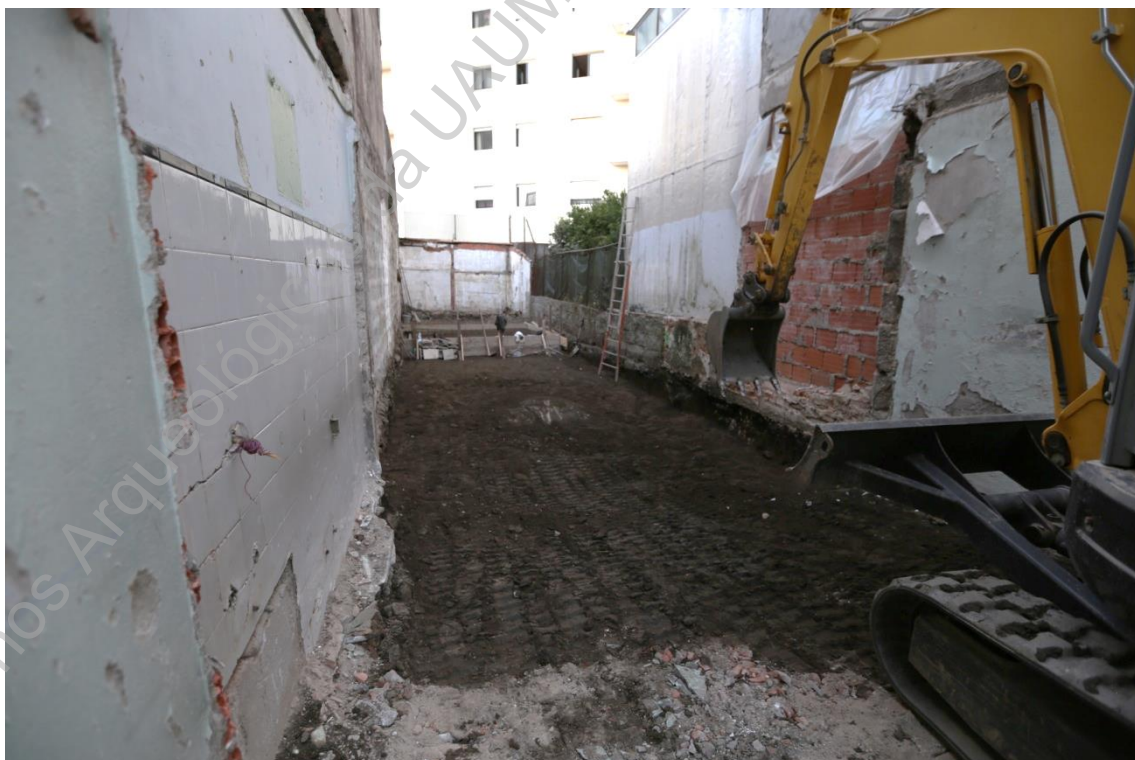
(IMG_5419) –Aspeto geral do trabalho de decapagem do terreno.
